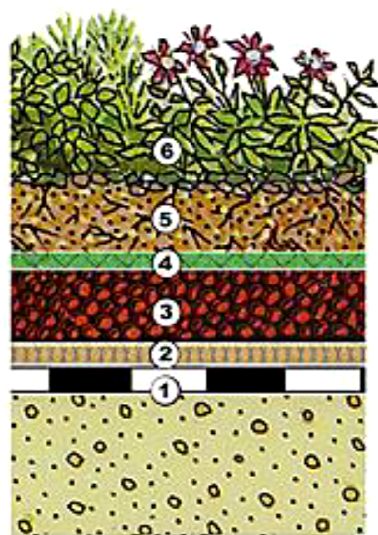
Exemplo de telhado verde de uso intensivo - Houston, USA
